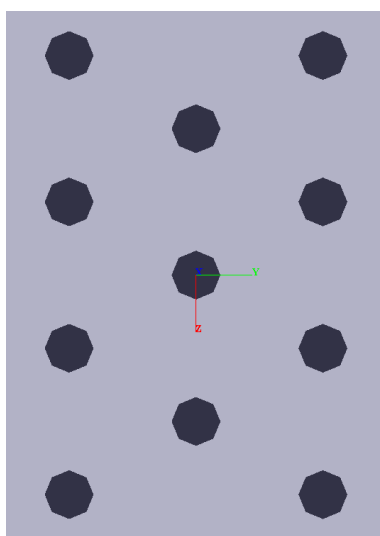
Vista planimetrica del modello GROUPv2016.
